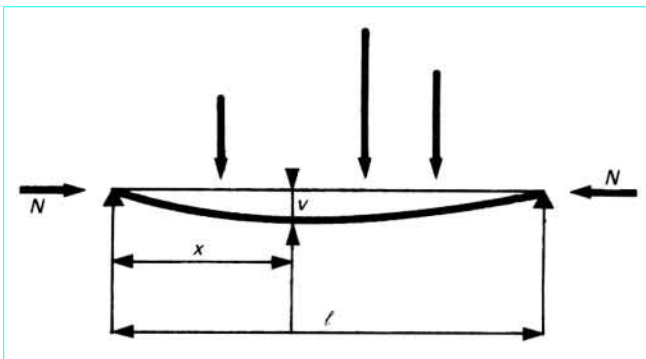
Poutre sur appuis simples comprimée et fléchie
